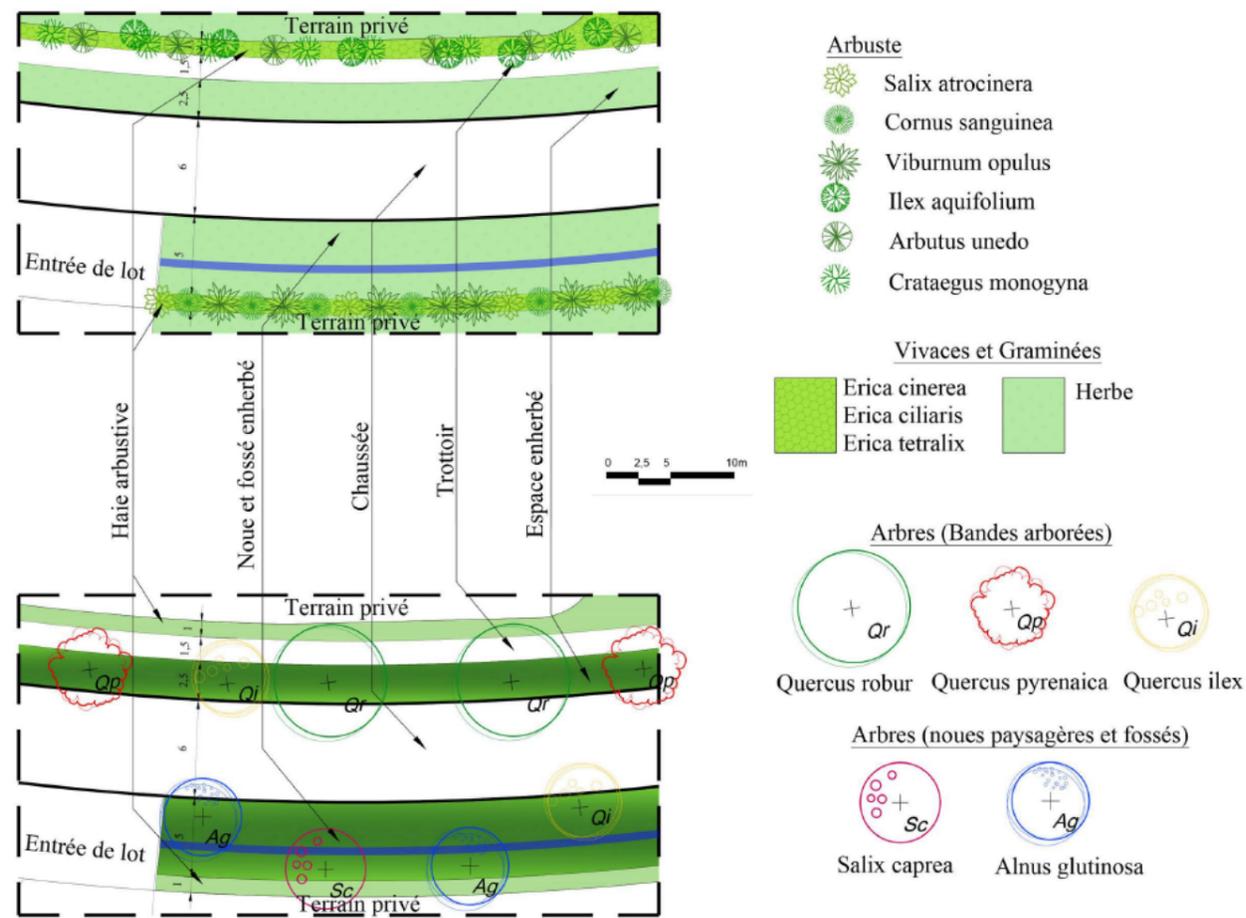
Plantations sur les voies 1 et 2 de desserte des lots
